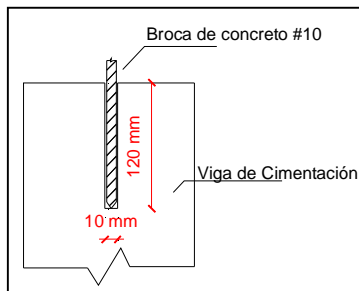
Corte transversal del anillo de cimentación para anclaje de refuerzo del murete M1.
